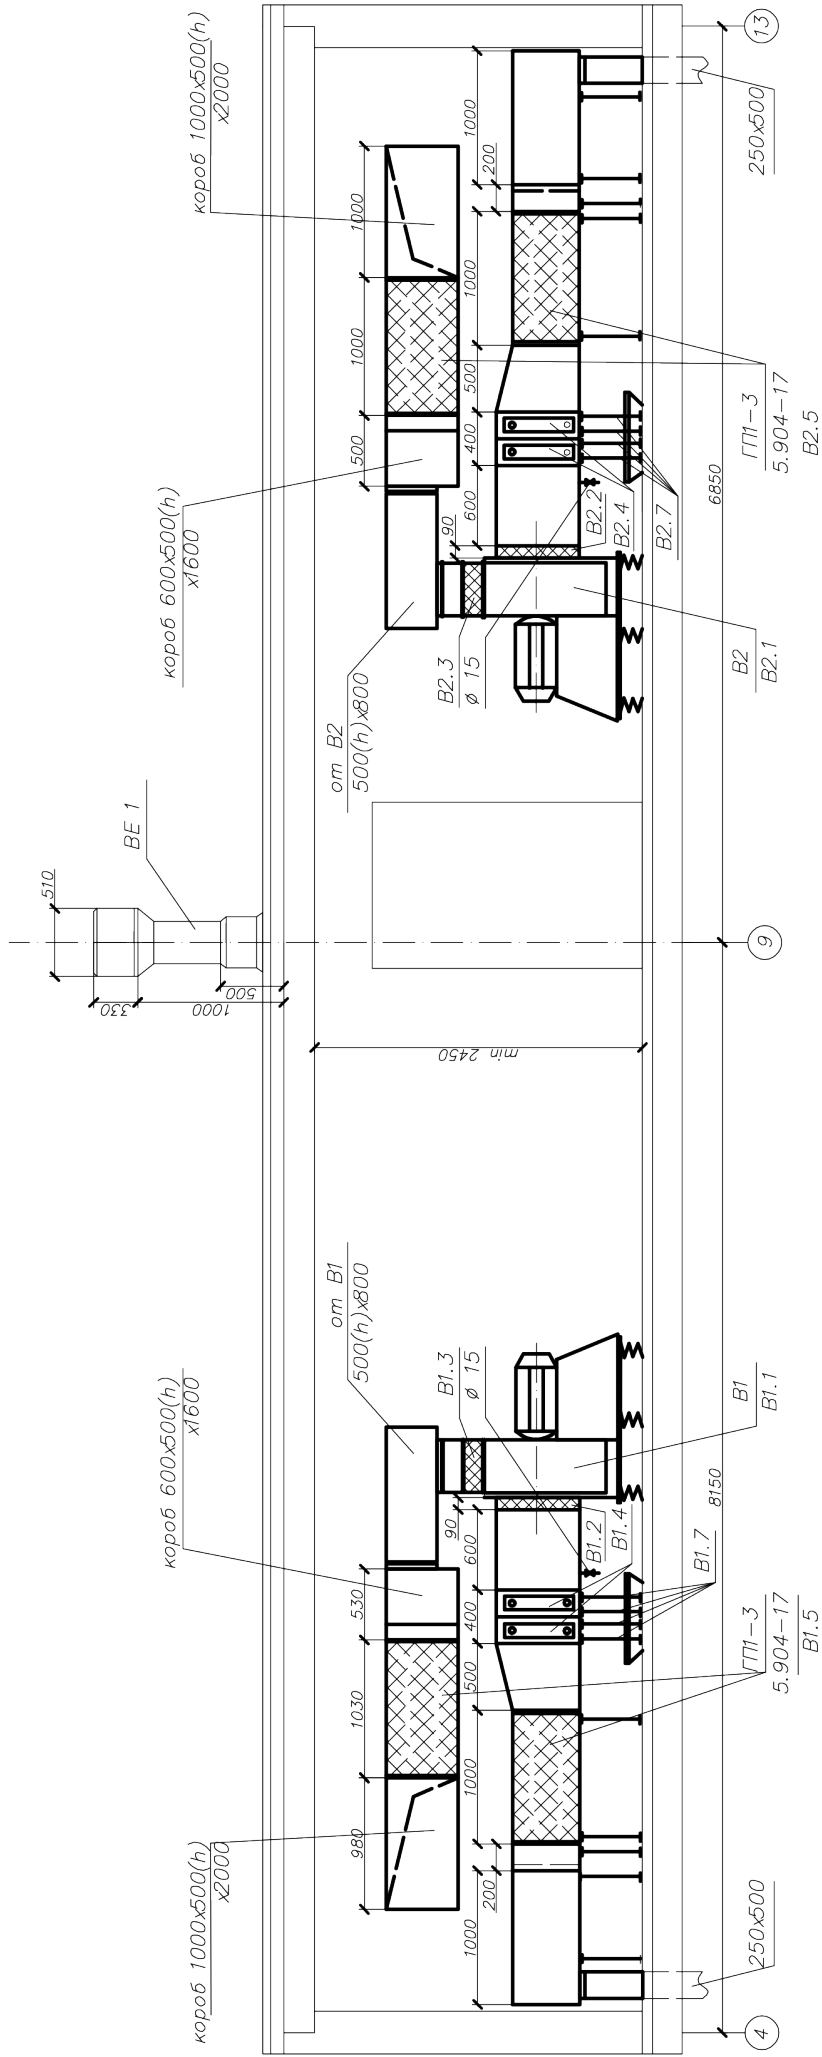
Разрез помещения с оборудованием для утилизации тепла ветвыбросов
